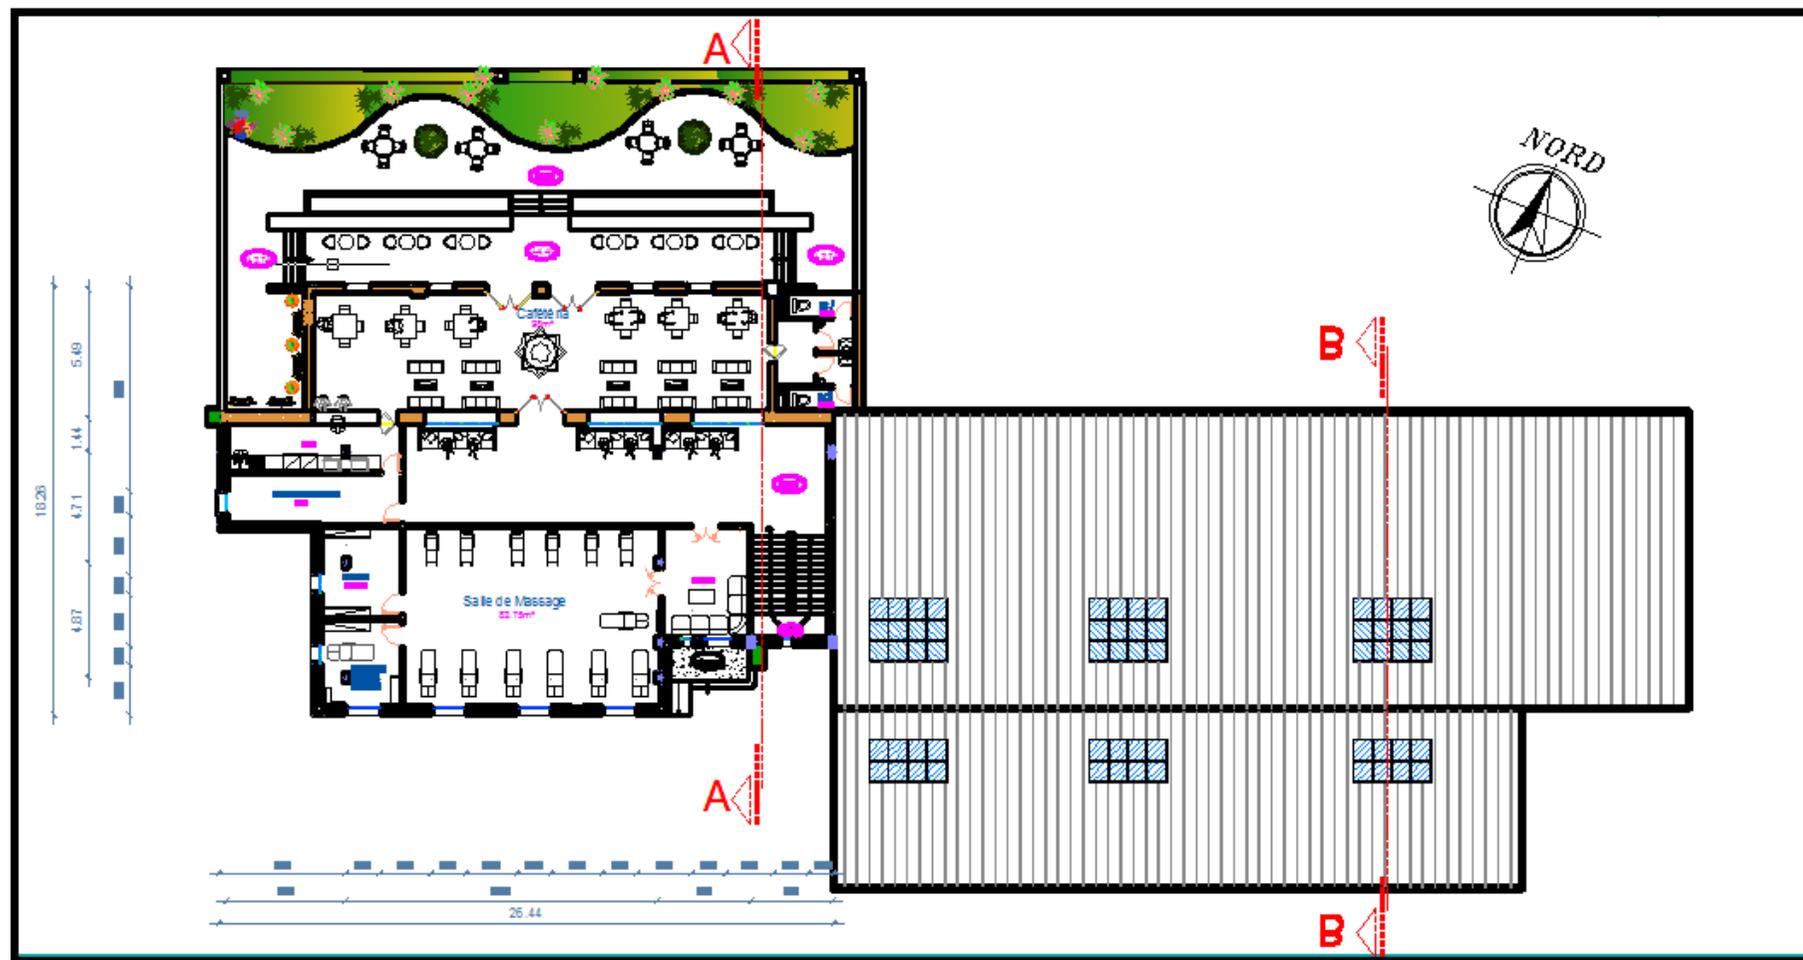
plan architectural d'étage (+4,42) de centre sportif
